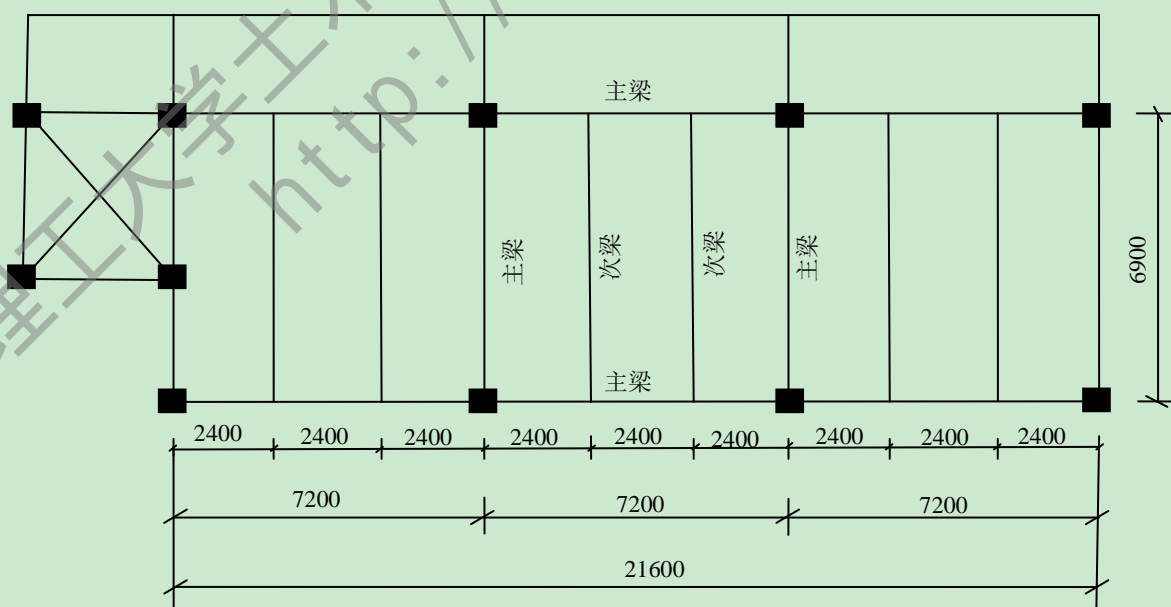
钢-混凝土组合楼盖平面布置图 (单位：mm)
